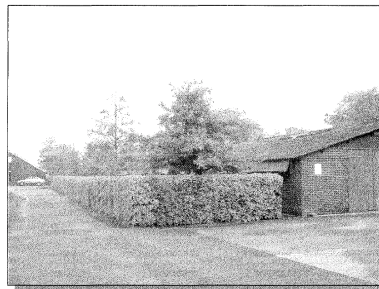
Gezamenlijke inrit en te slopen kuikenstal.
